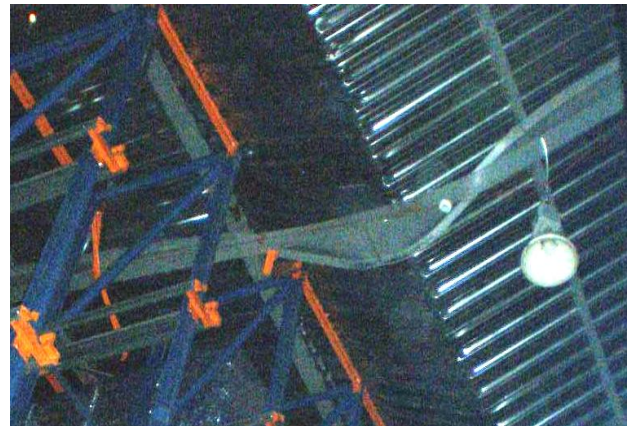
Прогиб стропильной балки с кручением / Deflection of truss beam with torsion
